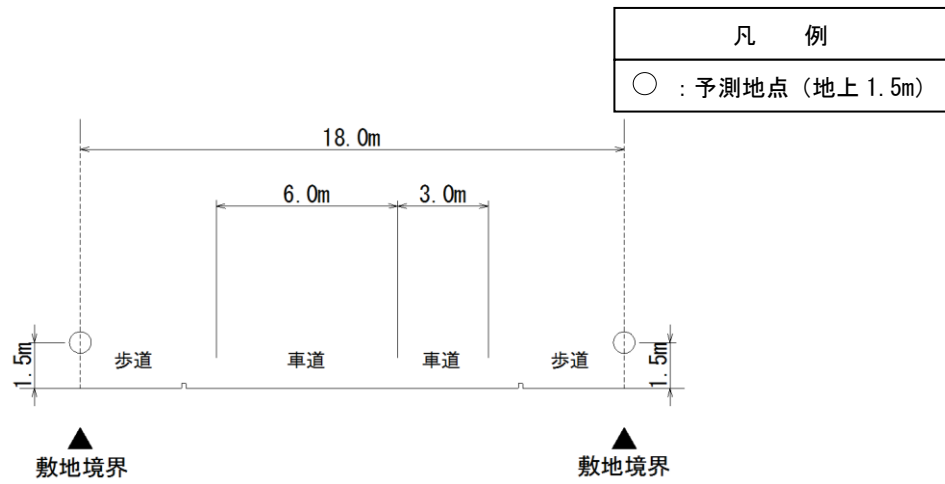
(4) 予測断面図 (D. 市川柏線)
